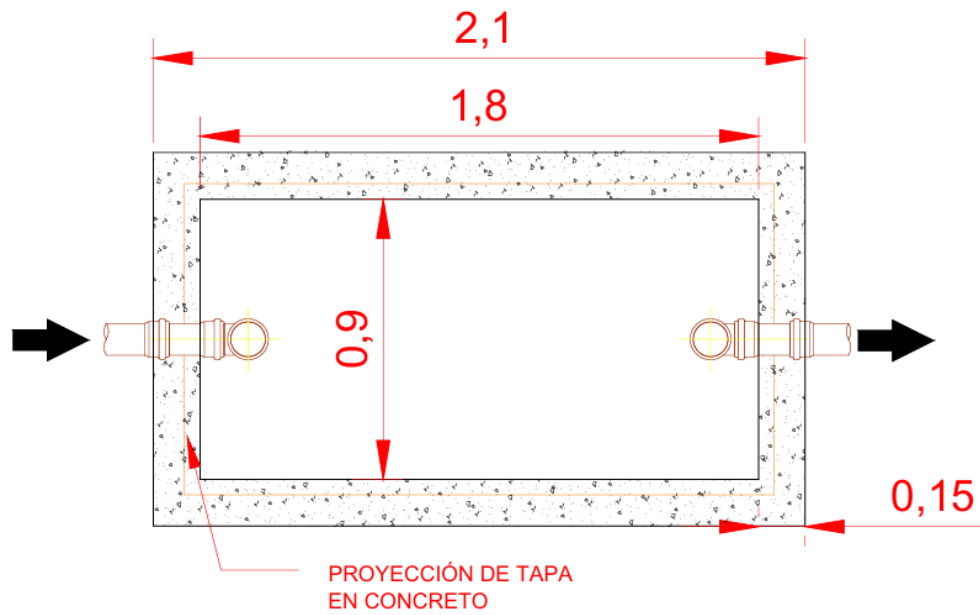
Vista en Planta de Trampa de Grasas. Escala 1:75.
